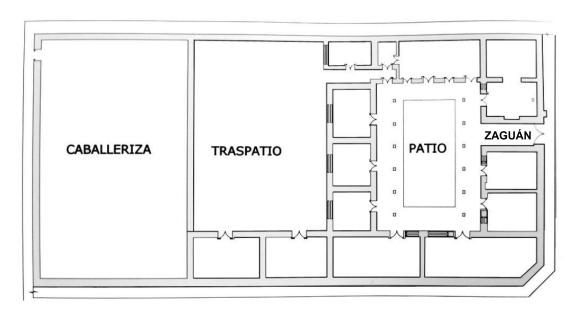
Planta arquitectónica de un inmueble tradicional de la ciudad de Loja
